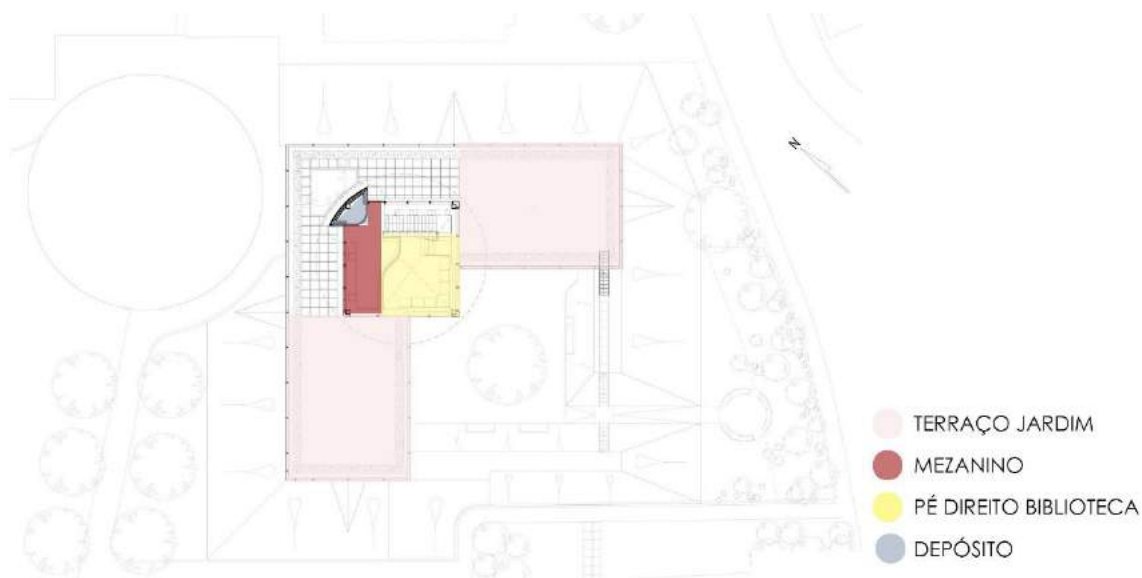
Planta segundo pavimento setorizada. Fonte: ArchDaily.
